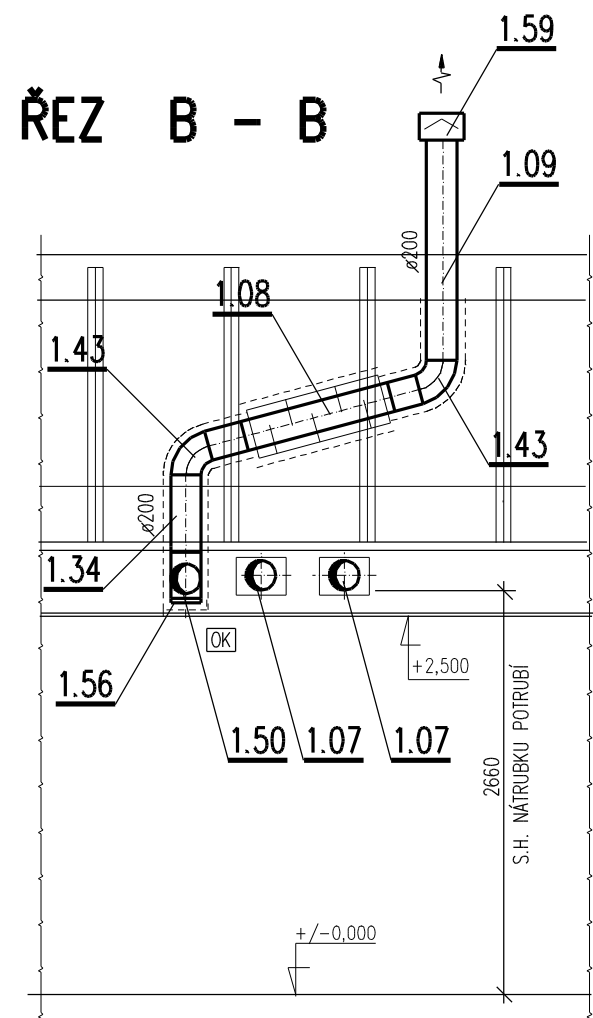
DETAIL KŘÍŽENÍ POTRUBÍ v m.č.1.07,1.09
